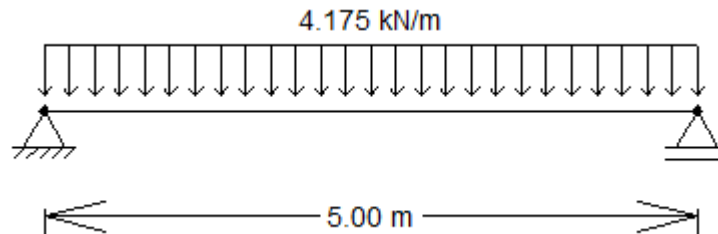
Sistema estático da viga 1 ou 2 com esforço transmitido da laje
